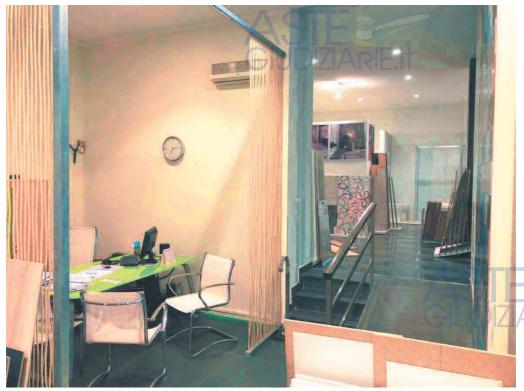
Area dell'altro, che insiste nell'area che dovrebbe essere a deposito. Il vano dopo la rampa appartiene al sub.25
